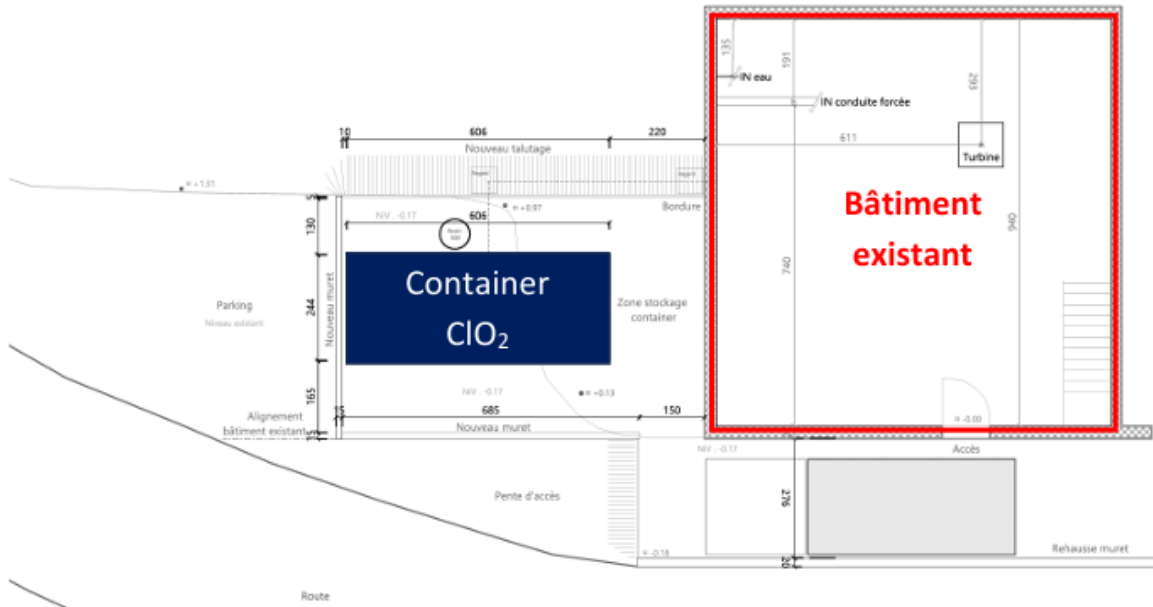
IMPLANTATION DU CONTAINER SUR LE SITE DE PANEX.
